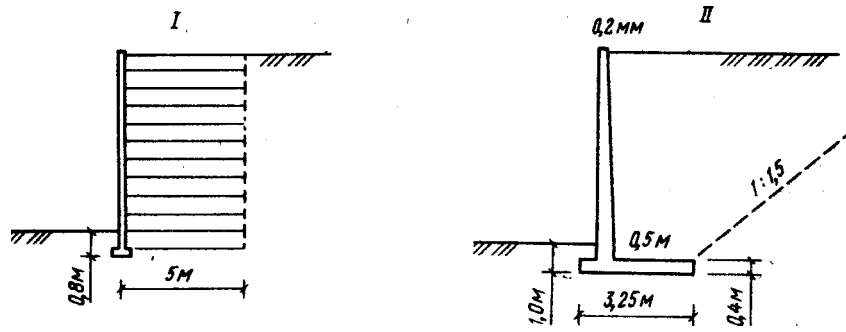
Сопоставление необходимых объемов грунта для возведения подпорной стенки из армированного грунта и железобетона.
